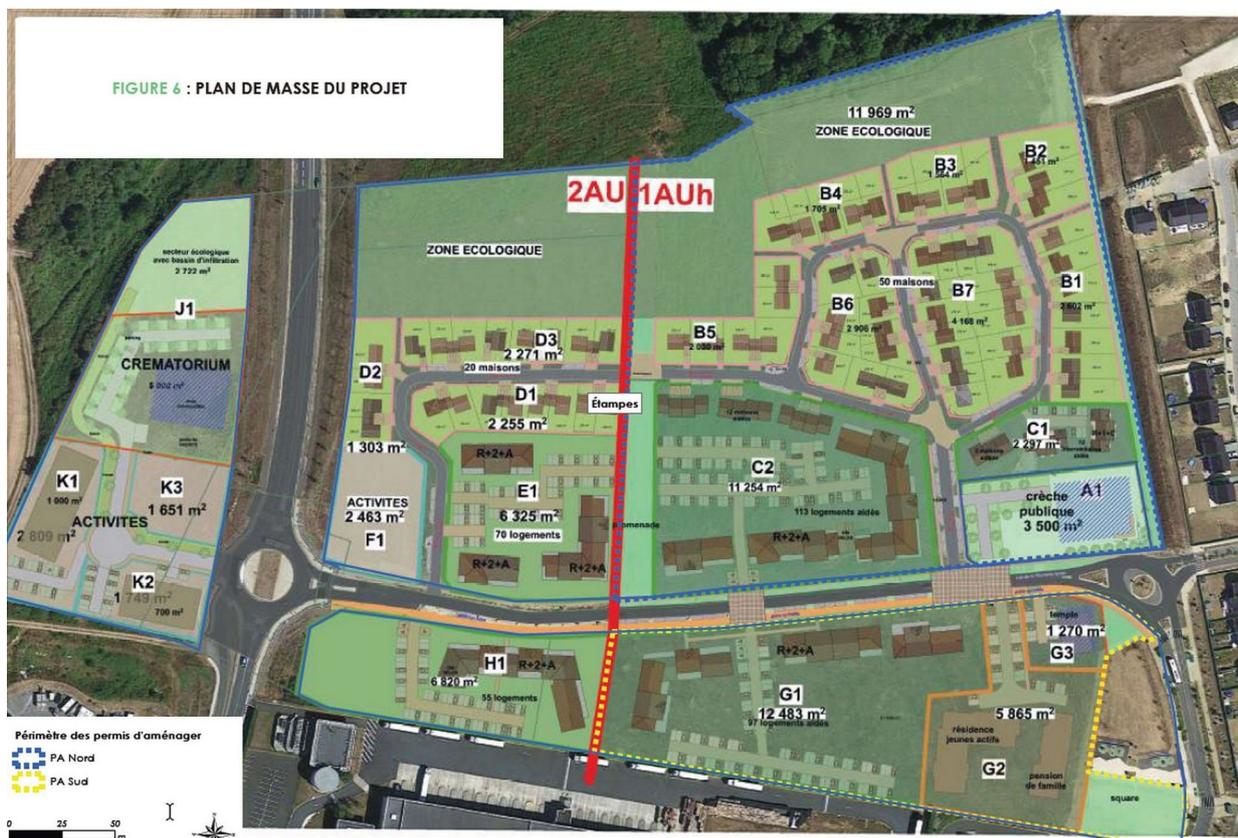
Plan de masse du projet d'aménagement du quartier du Bois Bourdon (étude d'impact, pp. 46-47)
